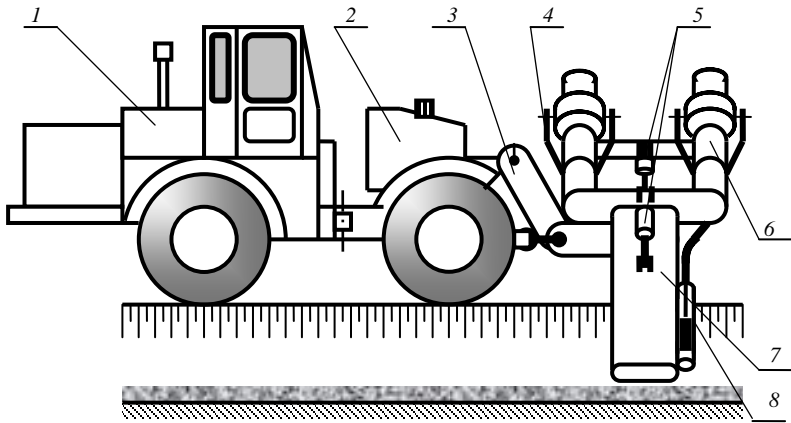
Схема газодинамического (газоструйного) каналоочистителя:
